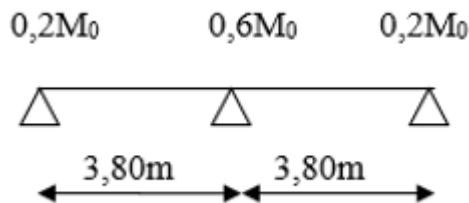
les types des poutrelles dans Plancher terrasse
